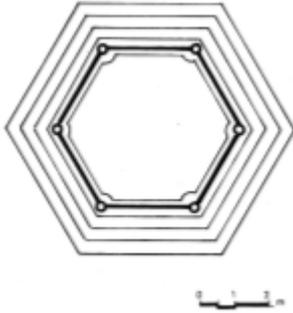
مسقط أفقي لترتبة محمد بك في البوسنة عن:
